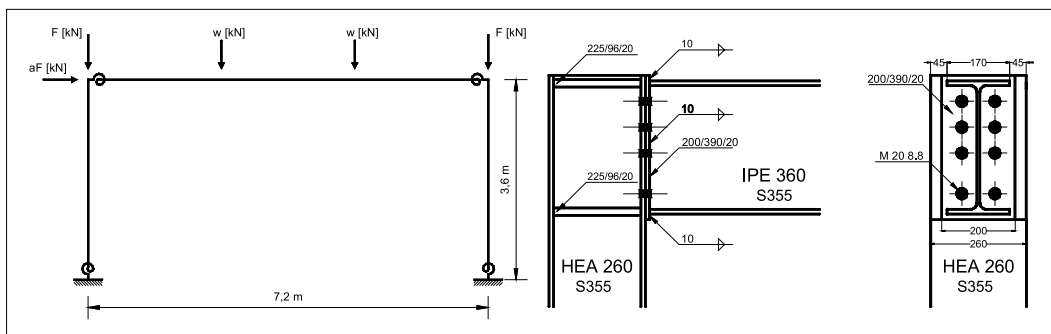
Pórtico de um pavimento e detalhes de suas ligações viga-coluna, Keulen et al. (2003).
